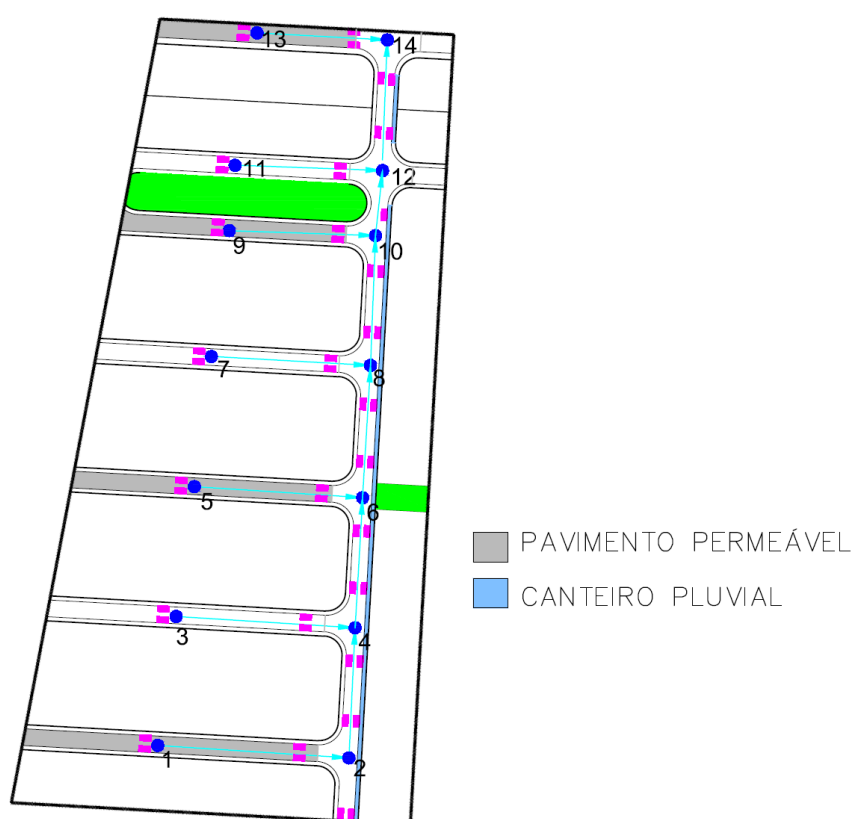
Disposição do pavimento permeável e do canteiro pluvial na área de estudo.
